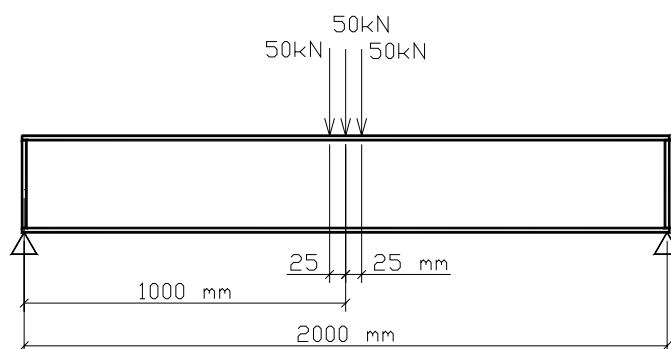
Carregamento aplicado nos modelos de viga de alma plana
